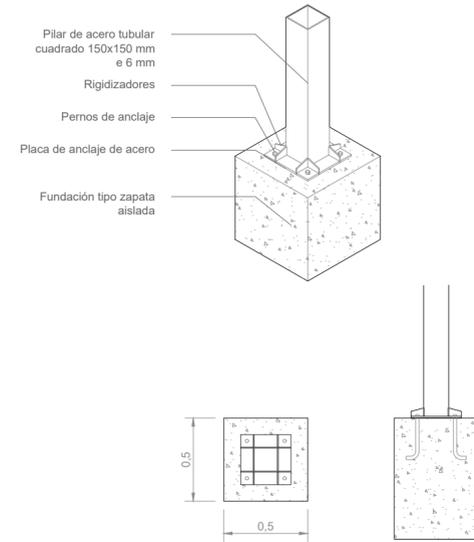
Fundación del pilar tubular cuadrado en zapata aislada. Fuente: Elaboración propia
